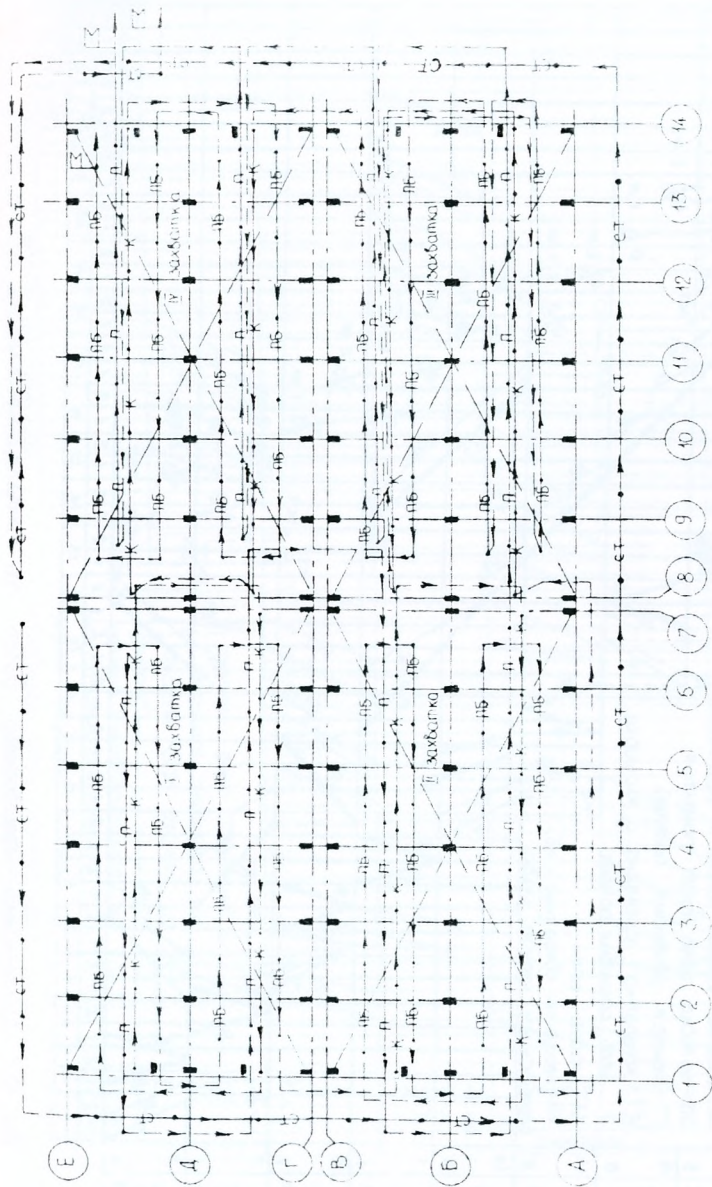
Схема размещения крана при монтаже конструкции одноэтажного здания
